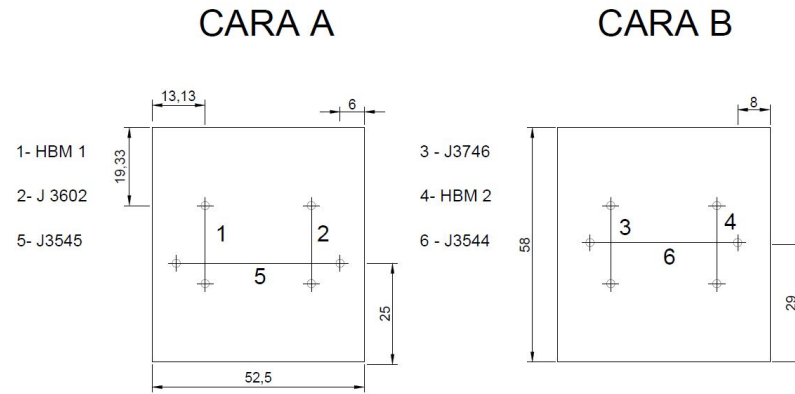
Posición de los transductores de desplazamiento en la primera pila.
